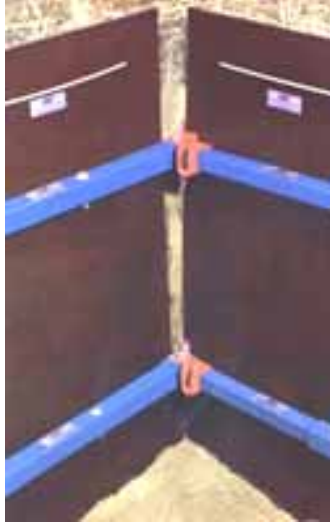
Le vérin hydraulique «Manhole Shores » de GME (Source : GME, 2006)
